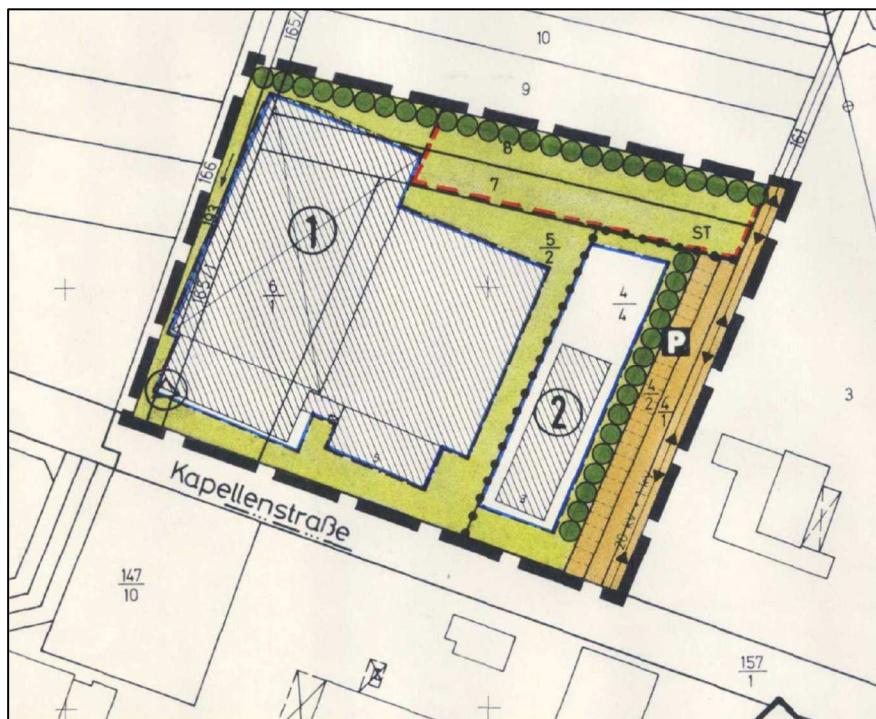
Auszug Planbild Bebauungsplan A 11.2 „Am Friedhof, 2. Änderungsplan“
